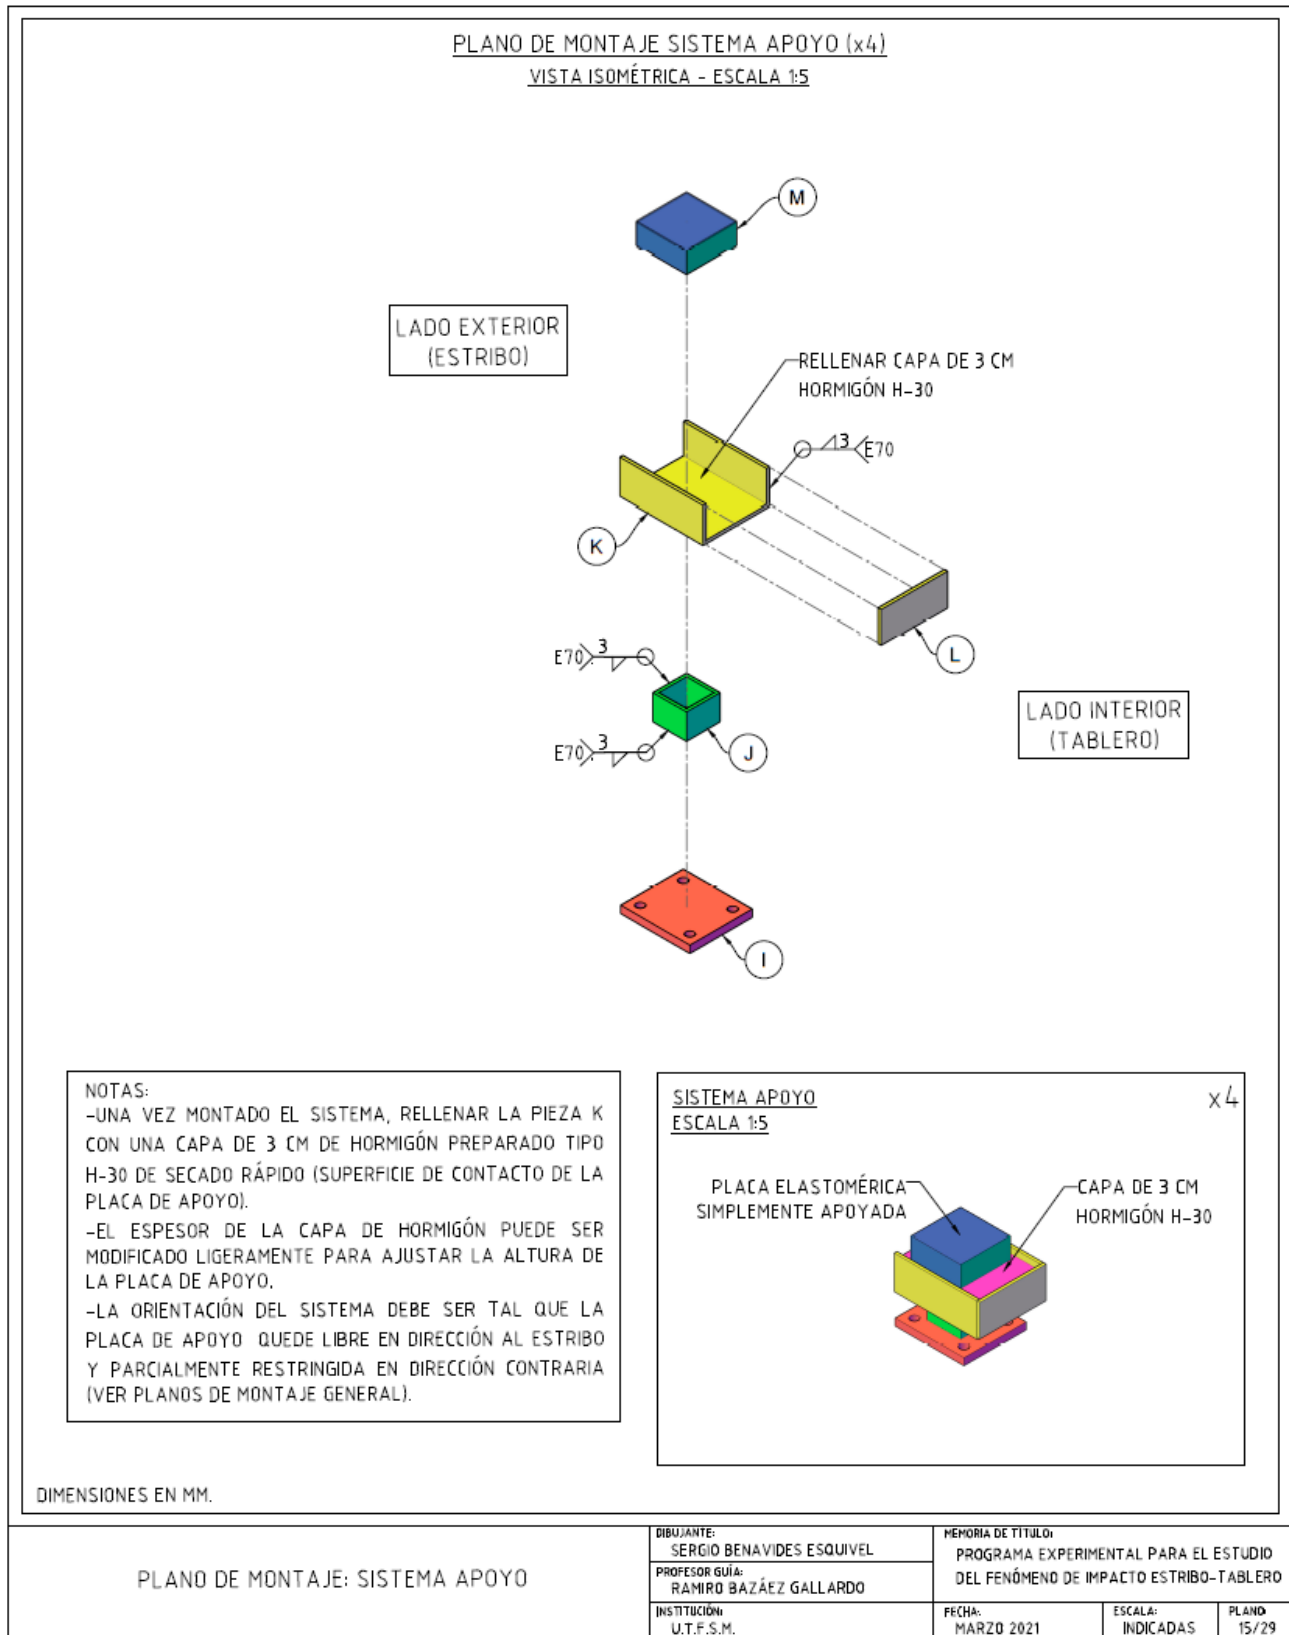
Plano de Montaje: Sistema Apoyo.
